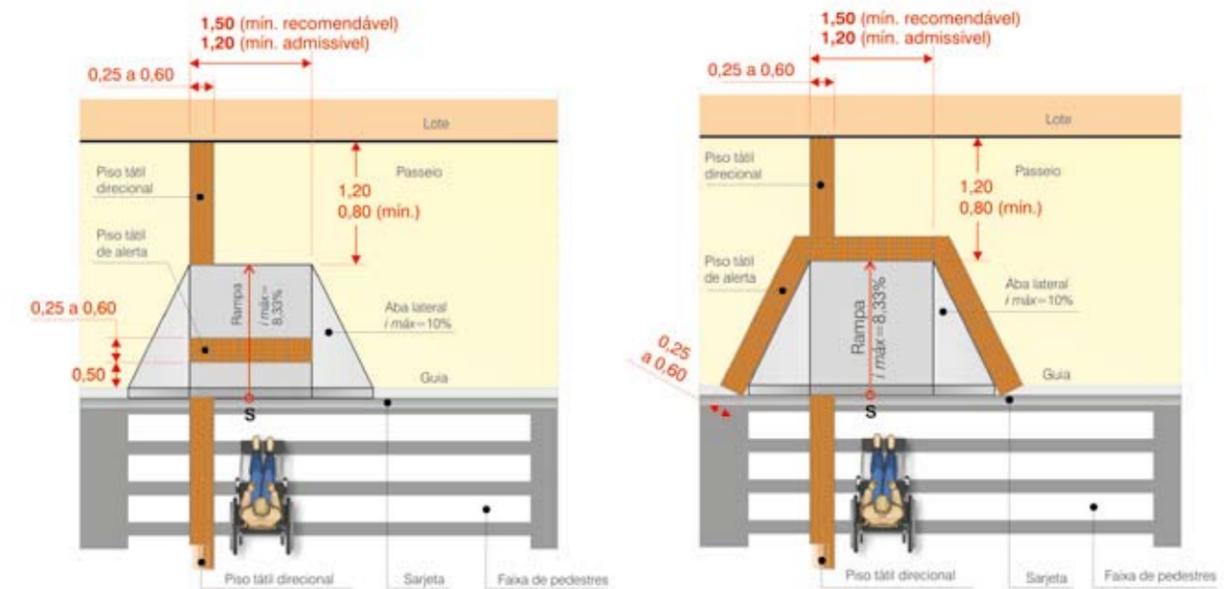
Rebaixamento de calçada com piso de alerta a 50cm do final da rampa Tipo A1
